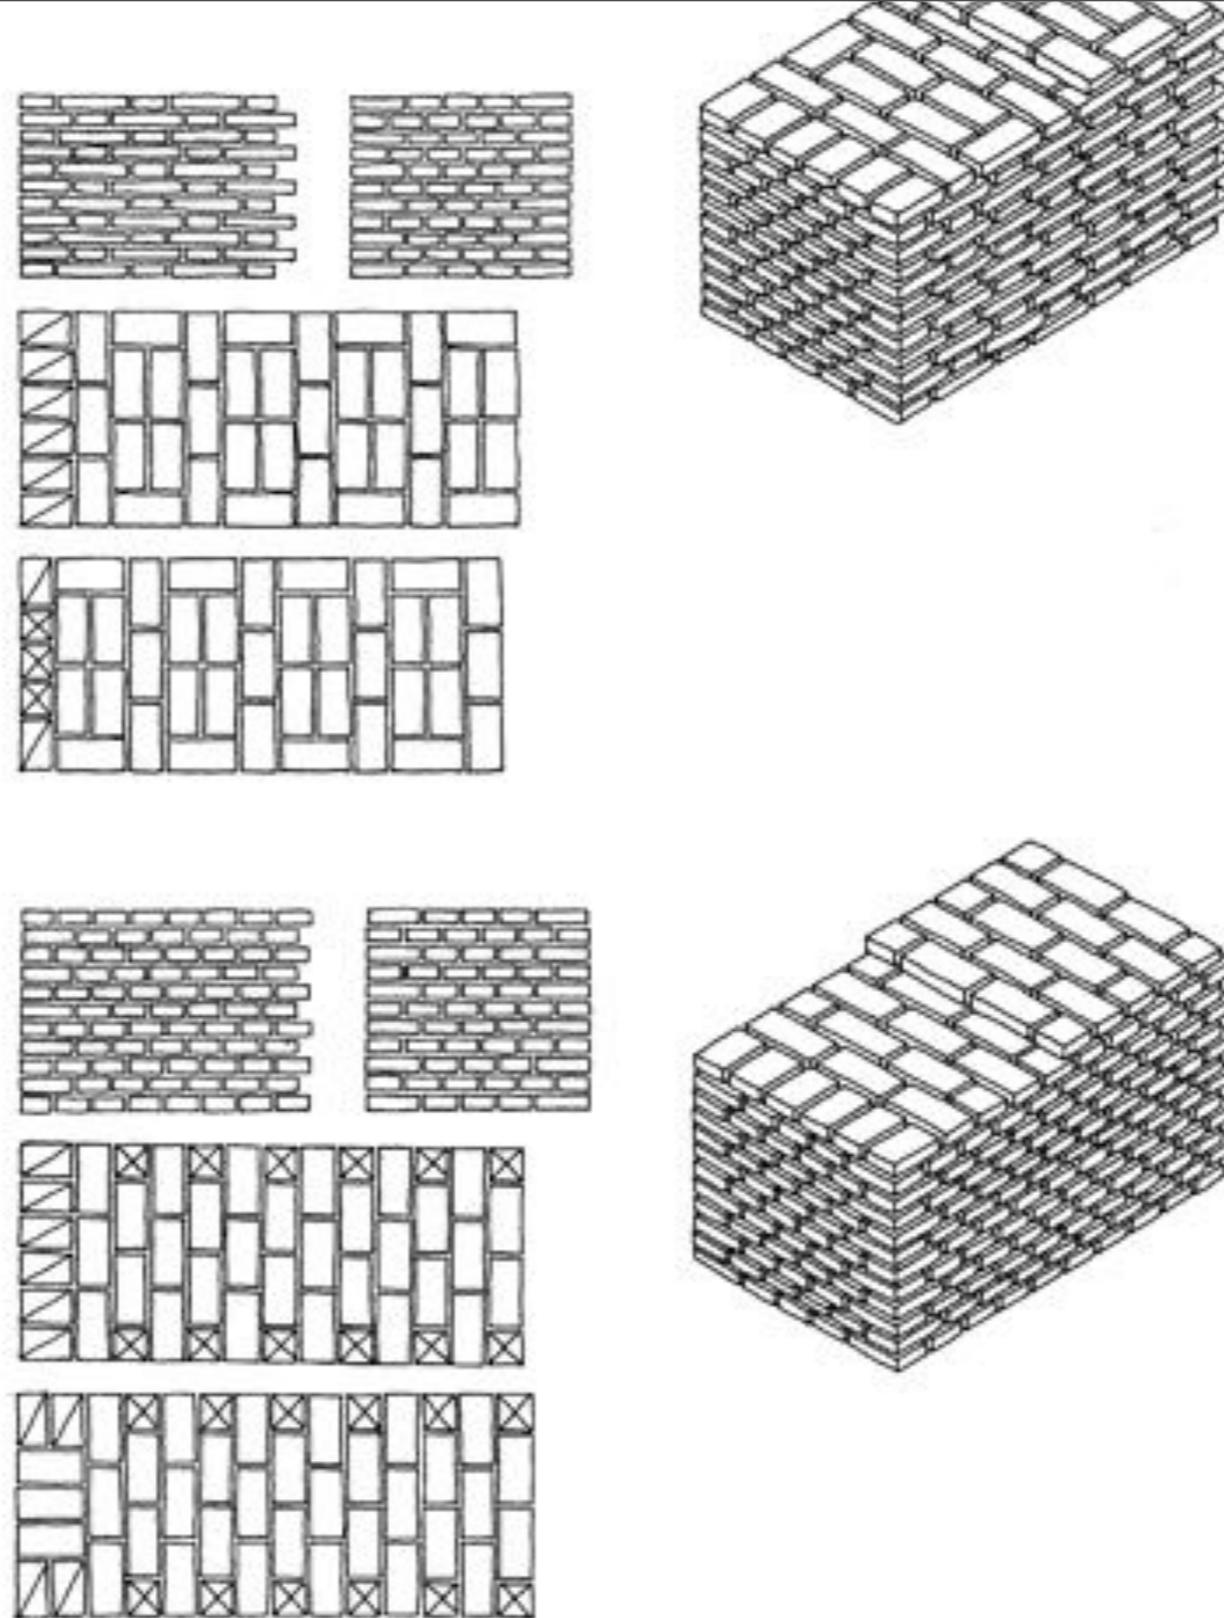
Schema in alto: muro a sei teste: concatenamento gotico. Veduta assonometriaca, prospetto, sezione e pianta dei corsi di mattoni; schema in basso: muro a sei teste: concatenamento in chiave. Veduta assonometriaca, prospetto, sezione e pianta dei corsi di mattoni
